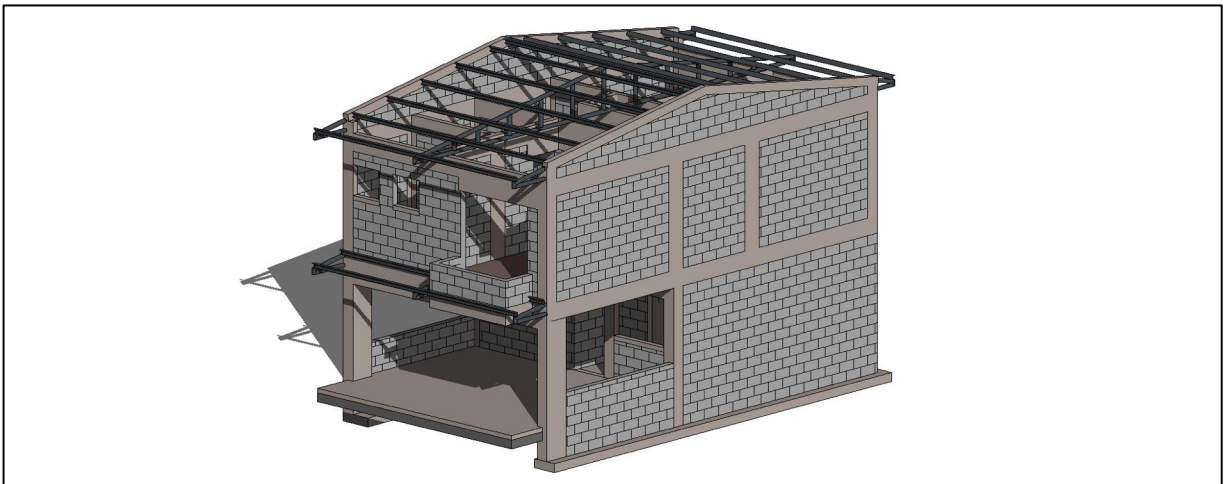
Vista general del Modelo BIM Estructural del proyecto seleccionado
